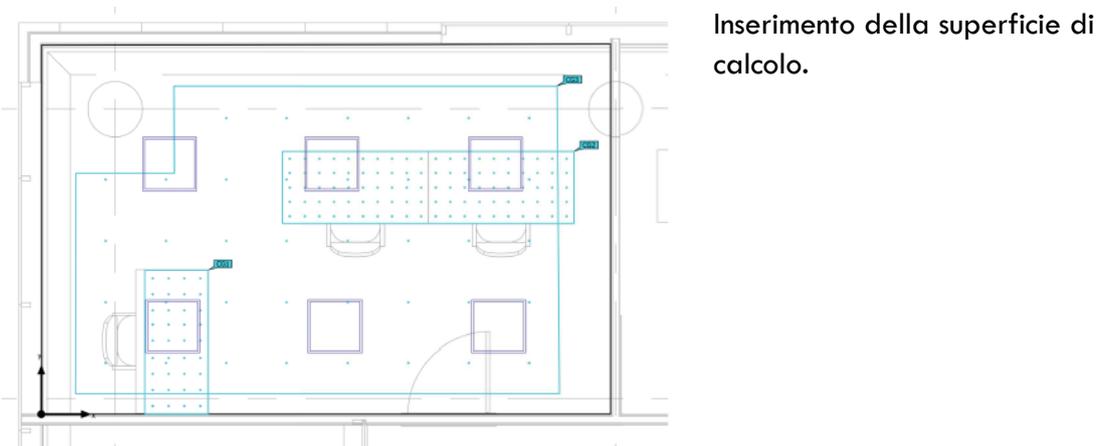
Vista in pianta dell'ufficio tipo nel software di calcolo
